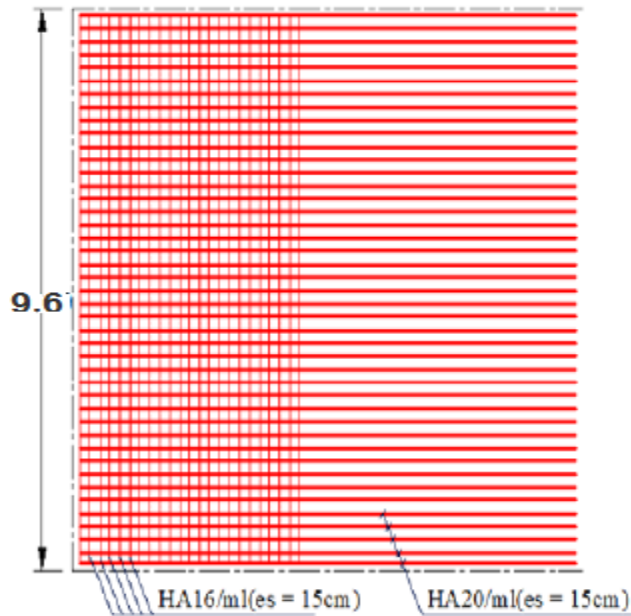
Ferrailage de la semelle (nappe supérieure)
